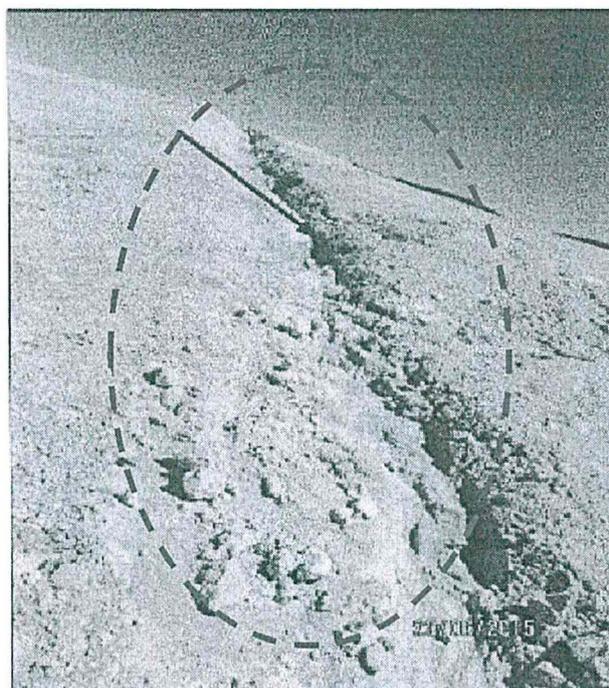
Vista de otro ángulo de canal de coronación en la cantera Sexi.
